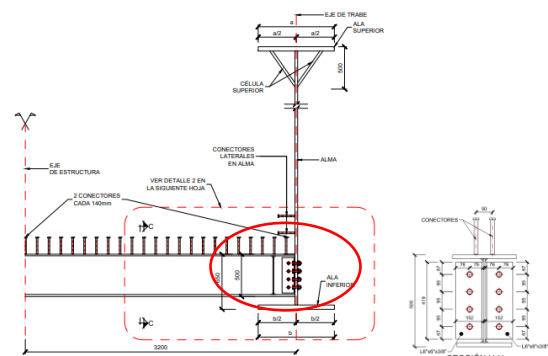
Unión atornillada vigas transversales intermedias con vigas longitudinales
